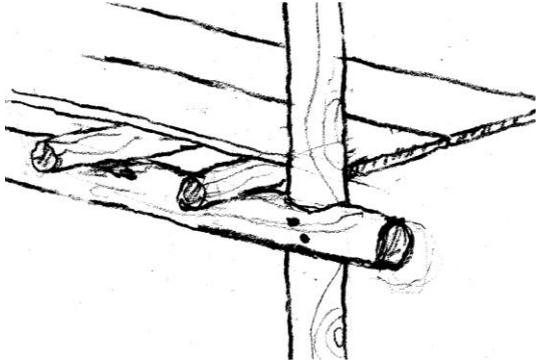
Konstruksi Tiang Rumah Suku Bajo
